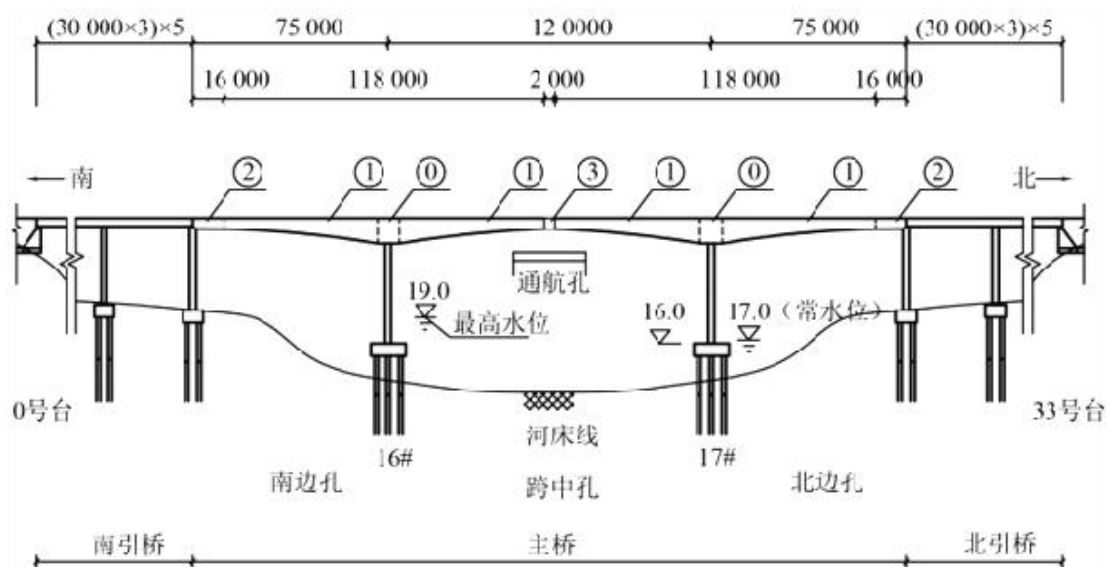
桥梁立面布置及主桥上部结构施工区段划分示意图
